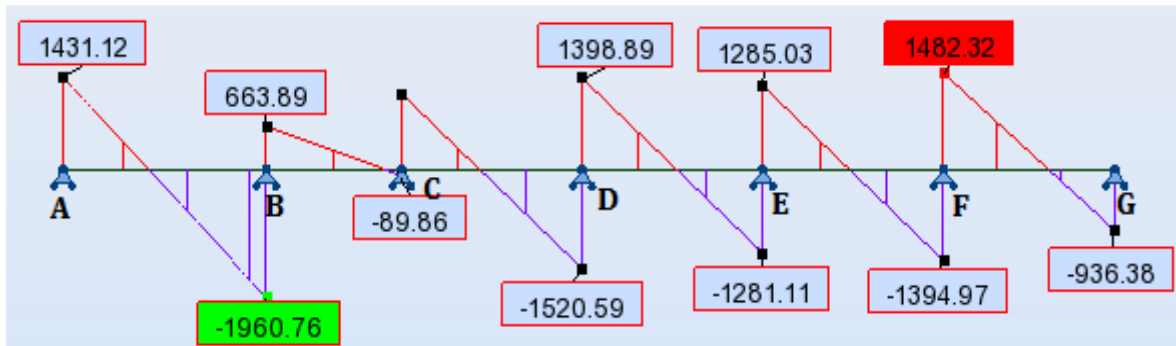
Schéma de la poutre (Nervure) la plus chargée suivant-Y
